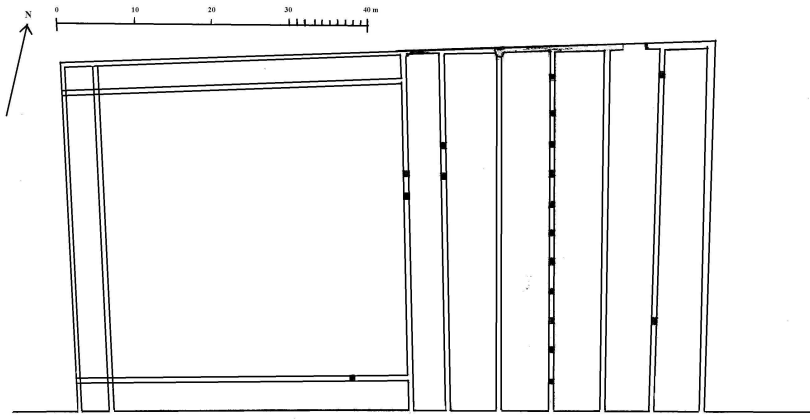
Ricostruzione della pianta di Aqsā I proposta dall'Autrice
